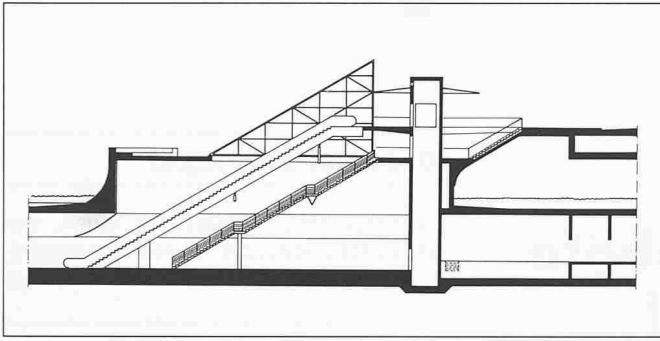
Längsschnitt (Massstab 1:200), rechts angeschnitten Sihlbrücke
